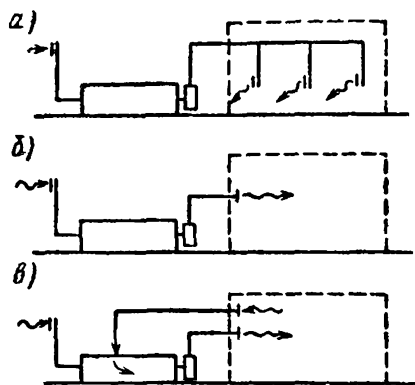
Схемы приточных систем общеобменной канальной вентиляции с механическим побуждением движения воздуха
